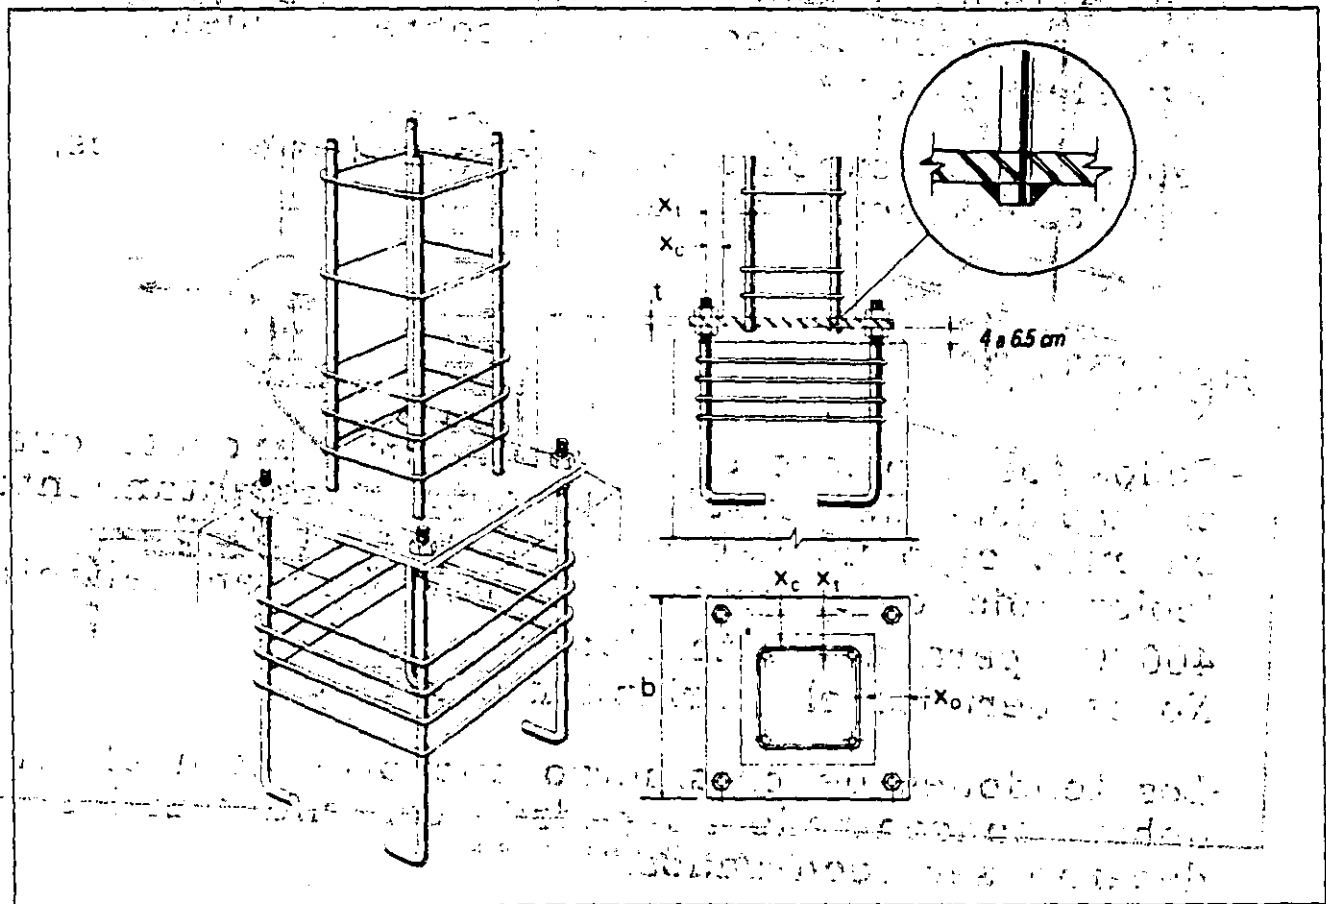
Placas de base de columna mayores que la sección transversal de la columna
